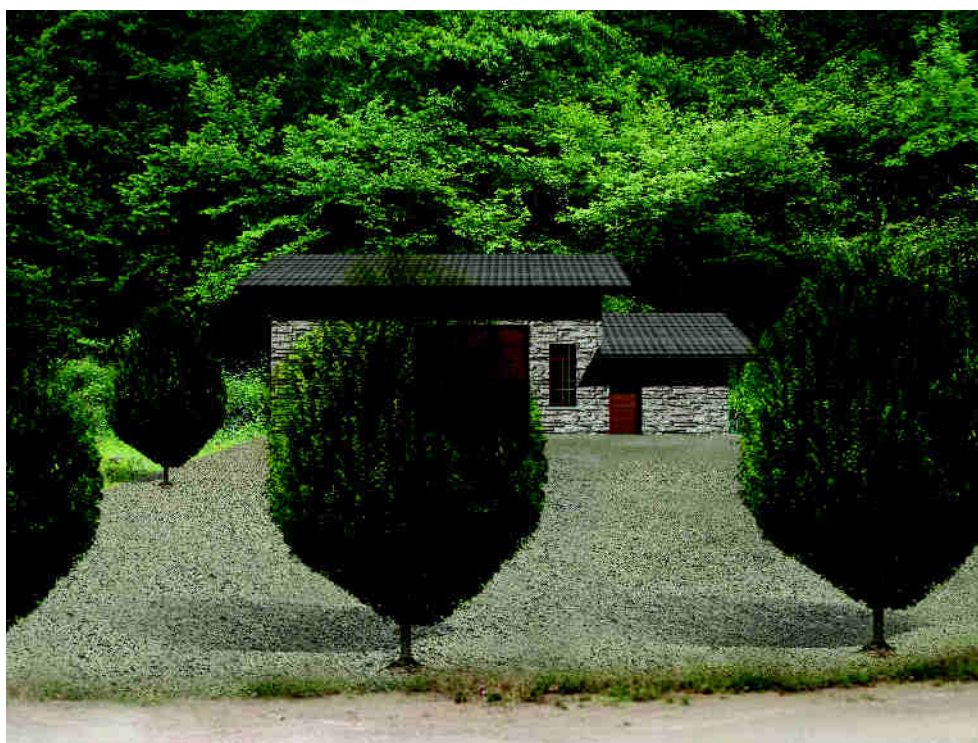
Foto inserimento n°3: vista del lato frontale dell'edificio di centrale da Via per Armeno
